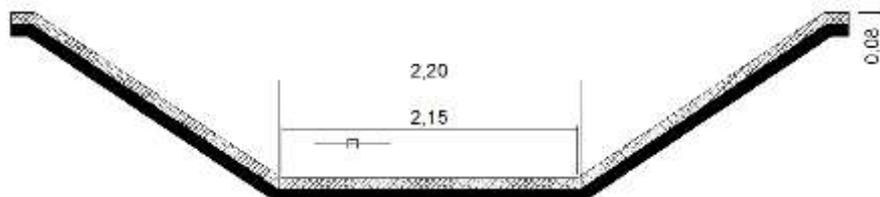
Coupe en travers des travaux de réhabilitation des canaux
